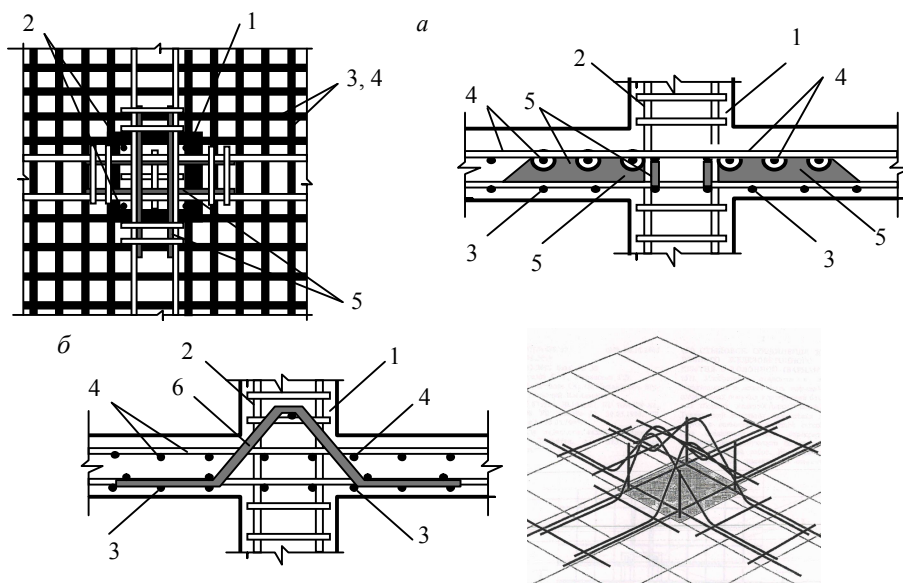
Схема стыкового соединения безбалочного железобетонного перекрытия
